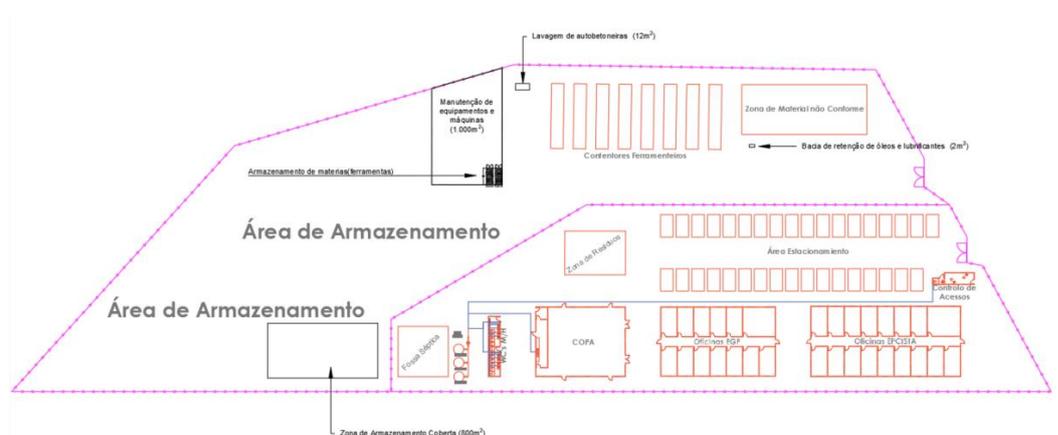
Imagem Exemplificativa da Planta de Estaleiro da Central Fotovoltaica de Concavada
